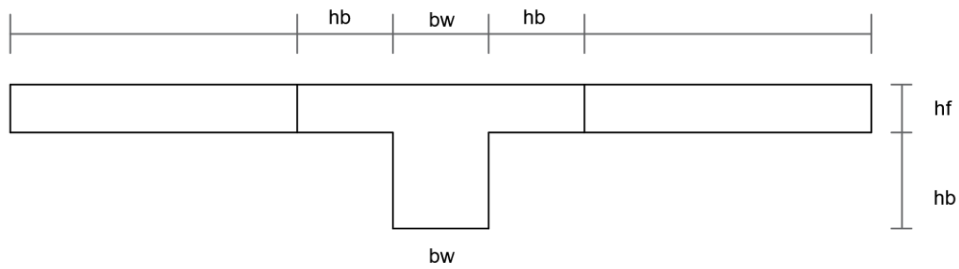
Sección de la viga analizada de la losa. (Jaén y Medina, 2023)
